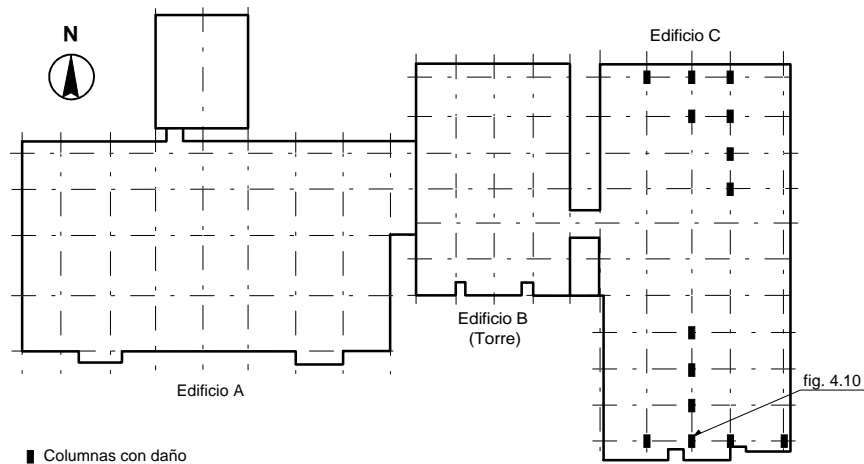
Localización de las columnas con daño por corte en el primer nivel
